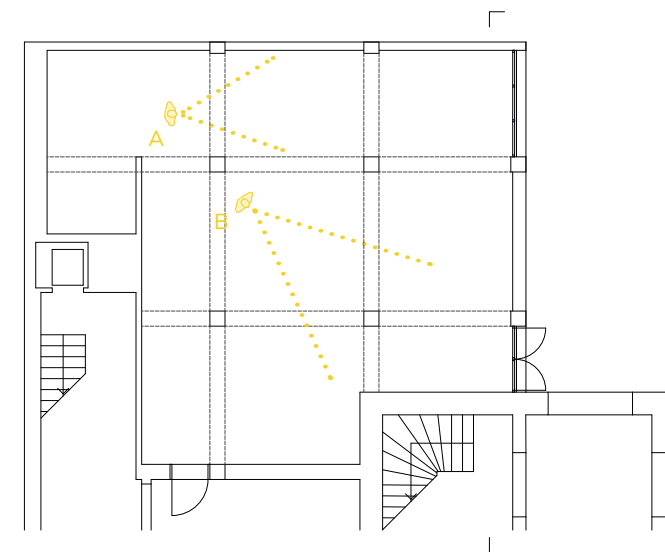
Grundriss Bildausschnitte unmöbliert
